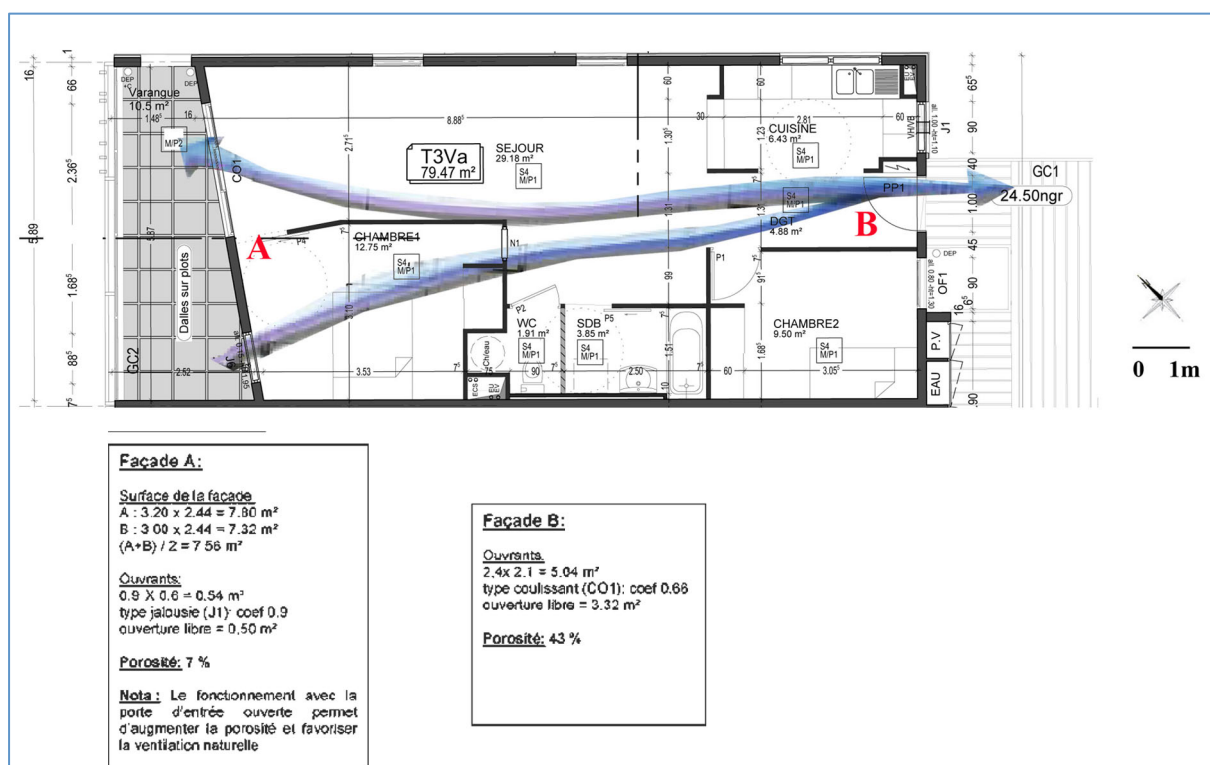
Florès et Malacca, Plan T3Va, Bâtiment Florès, Ventilation traversante [Agence 2APMR]
